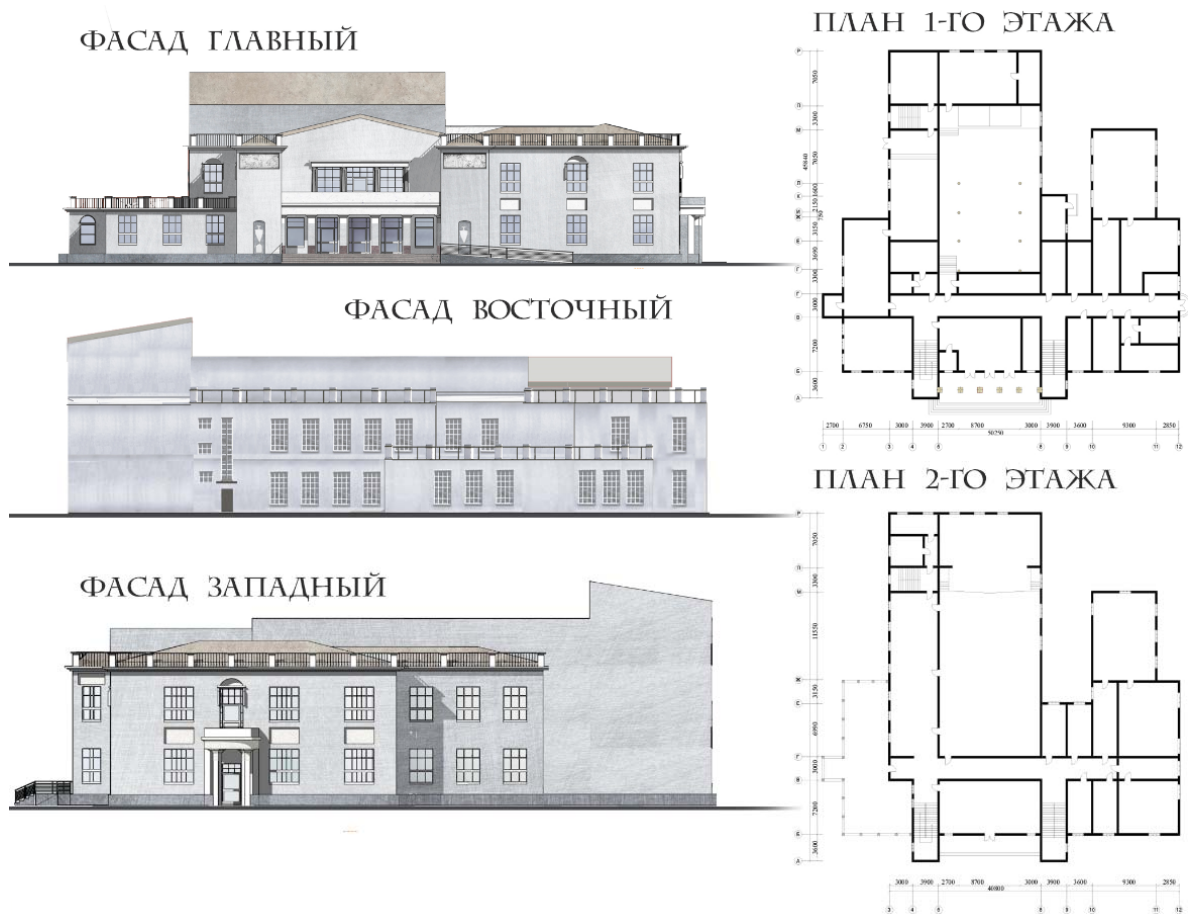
Фасады и планы ДК «Знамя Труда» в г. Тамбове
